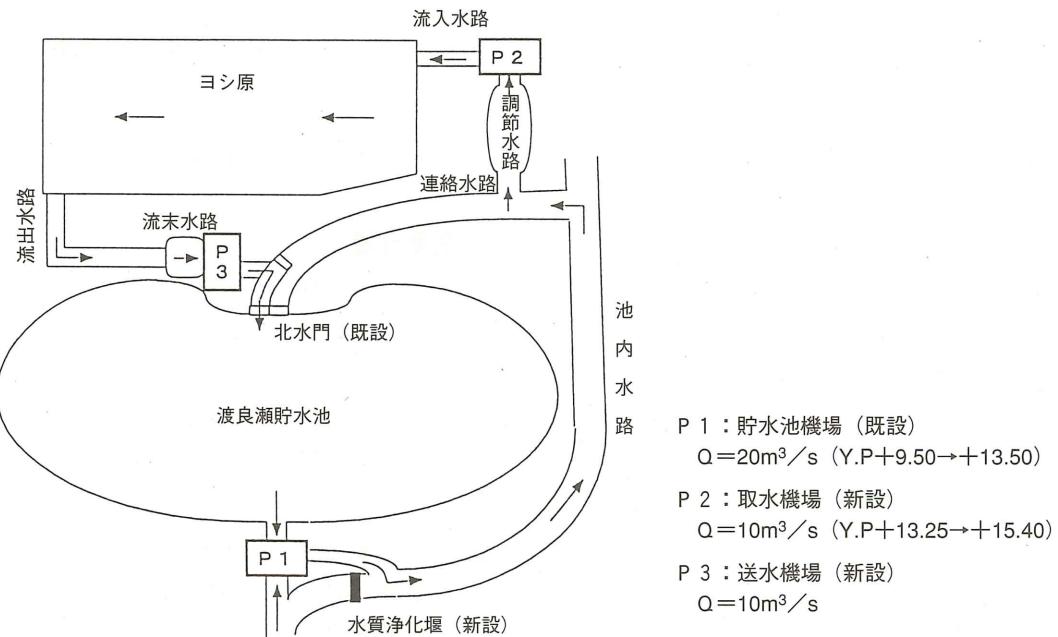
渡良瀬貯水池ヨシ原浄化施設平面図
